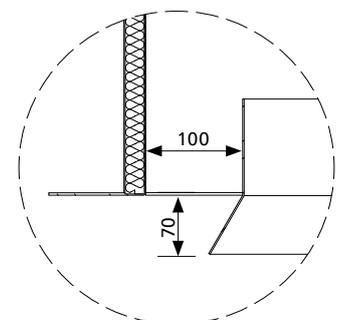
Schnitt durch einen RWA-Gerät mit eingebauter Einströmdüse
